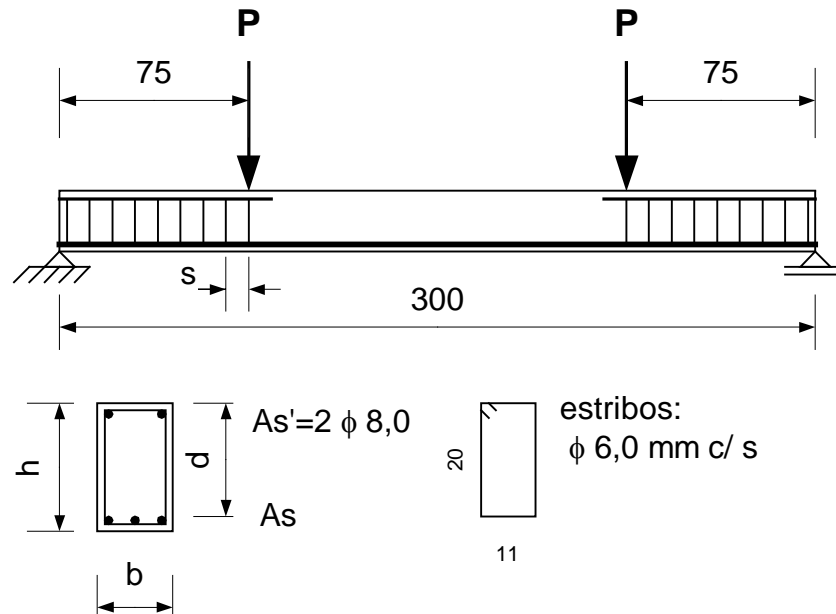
Geometria e carregamento das vigas ensaiadas por DECANINI
